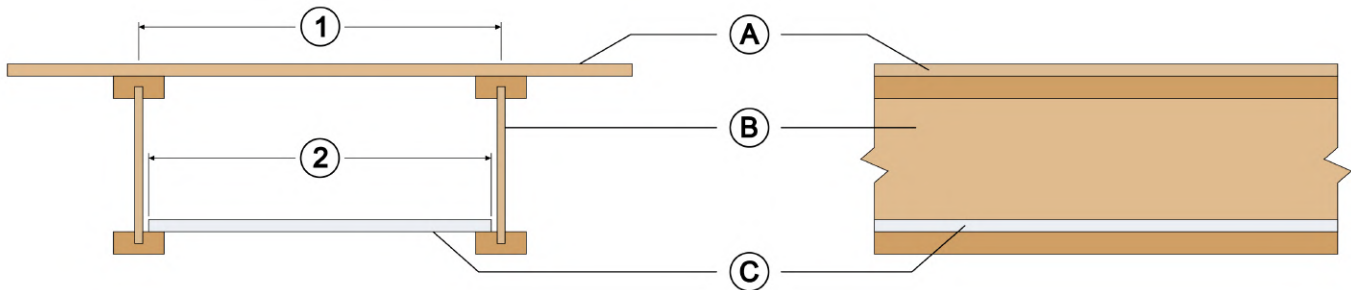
Protection contre l'incendie des planchers FP-06 : plaque de plâtre de 12,5 mm (1/2 po) posée sur le dessus de la semelle inférieure
